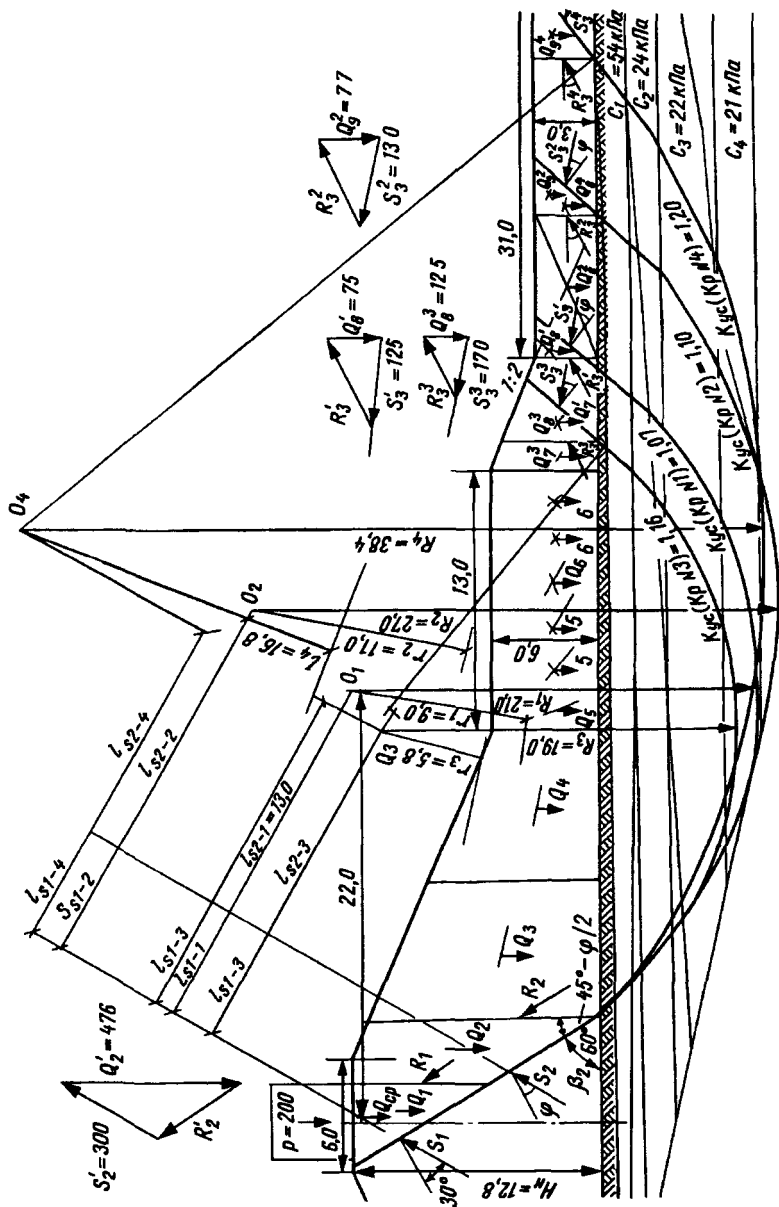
Расчетная схема проектирования пригрузочных берм. (Размеры в м)
